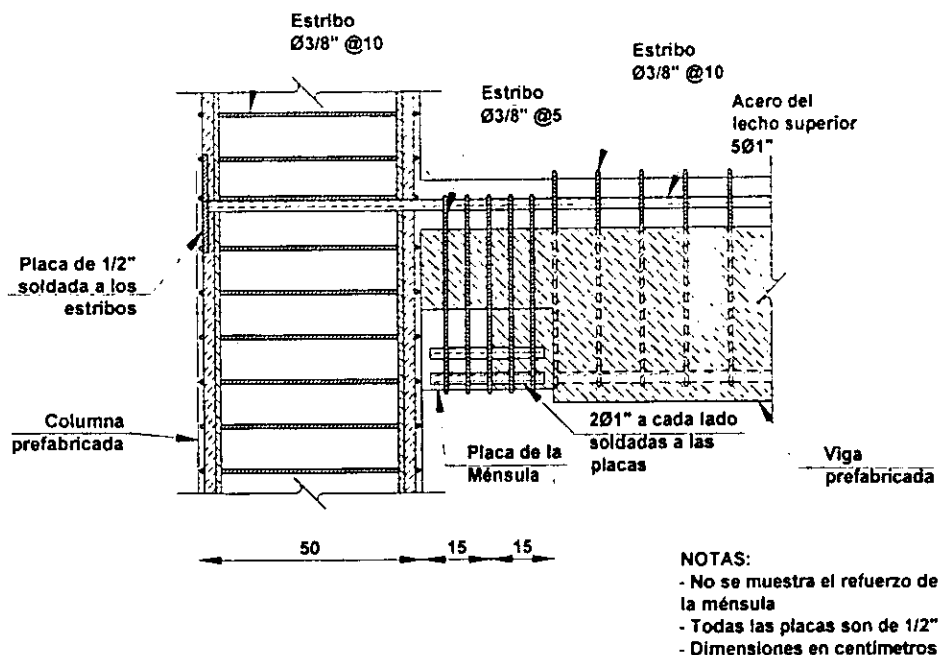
Detalle de unión viga columna [Zermeño, 1992] (continuación)
